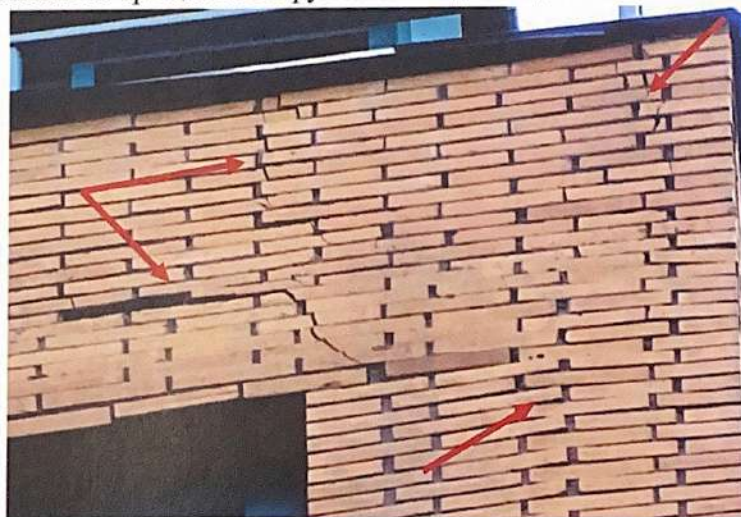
Секция 10. Фасад 2. Межсекционный деформационный шов не доходит до верха здания – причина разрушения вышележащей кладки. Диагональные трещины. Разрушение кладки над оконными балками. Деталь.
